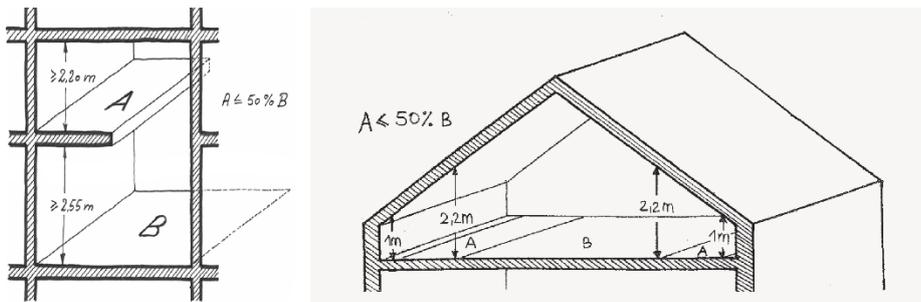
Hauteur libre sous plafond en cas d'une mezzanine ou de combles
